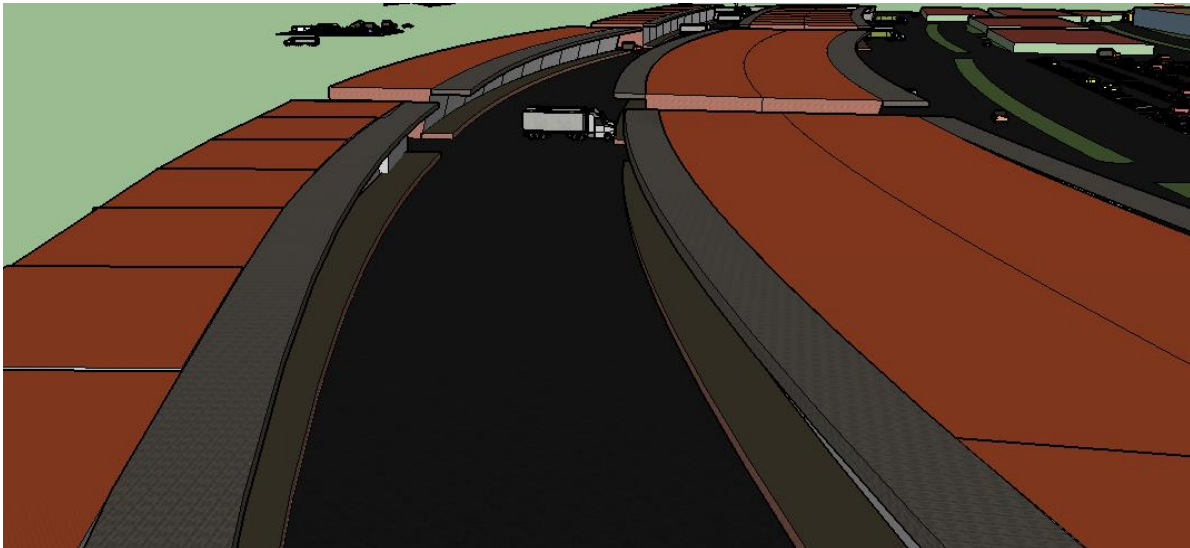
Render en donde se aprecia en primer plano las 6 naves destinadas
